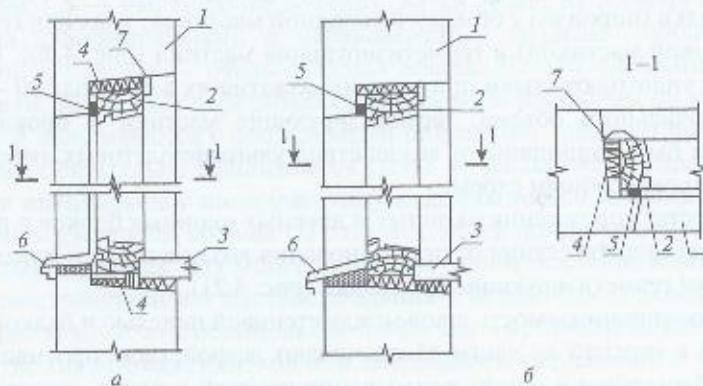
Герметизация мест примыкания оконных блоков к панелям наружных стен:
